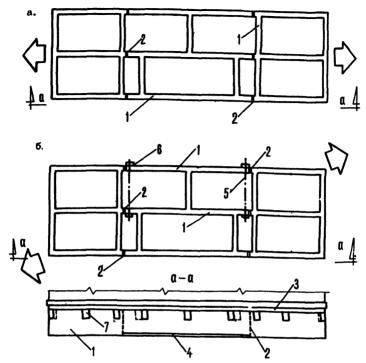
Схемы разрезки фундаментно-подвальной части здания, подлежащего выправлению, на короткие отсеки:
